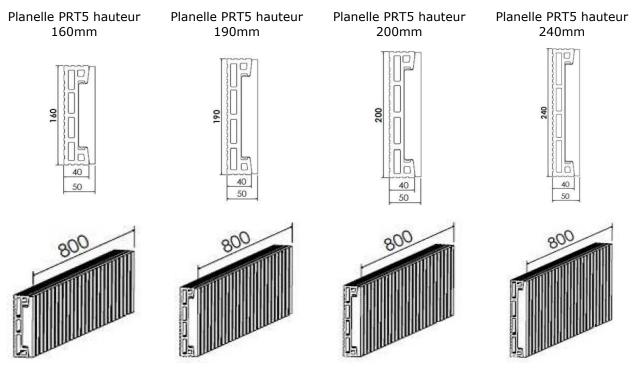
bis – Dimensions de la gamme de planelles PRT5
